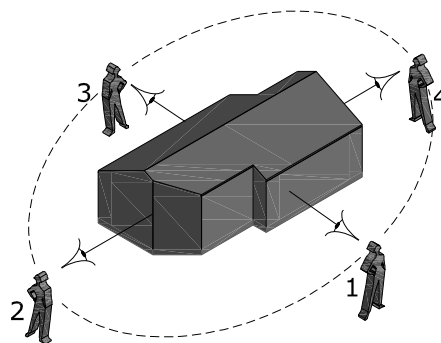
Positions de l'observateur pour des projections sur des plans horizontaux
